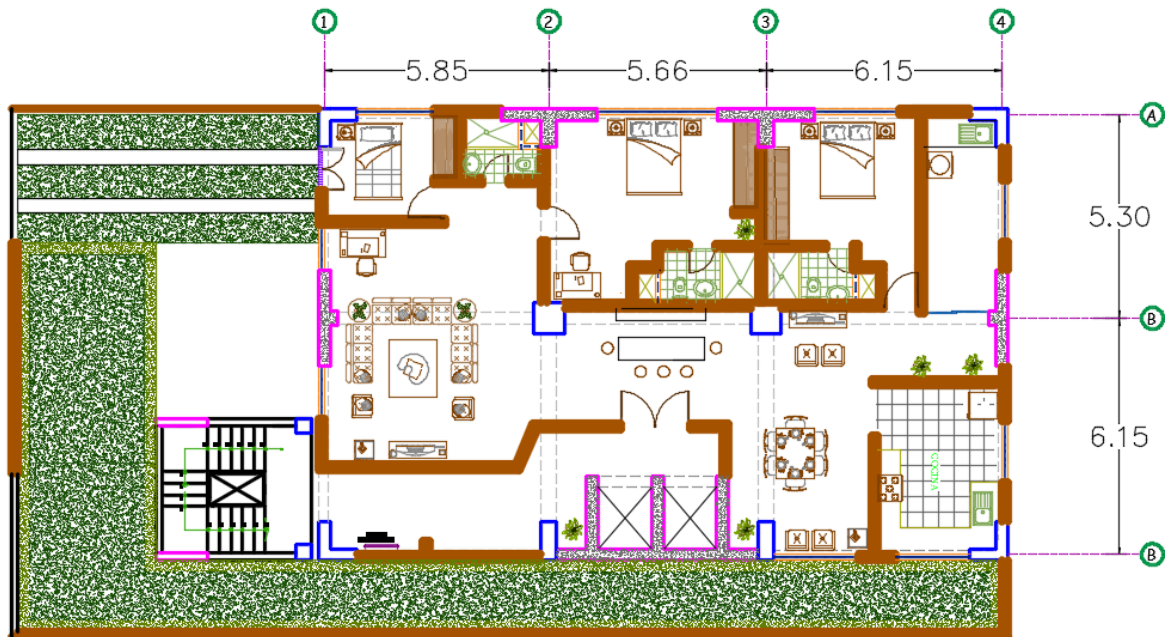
Plano Arquitectónico de la planta típica (2° al 12° piso).
